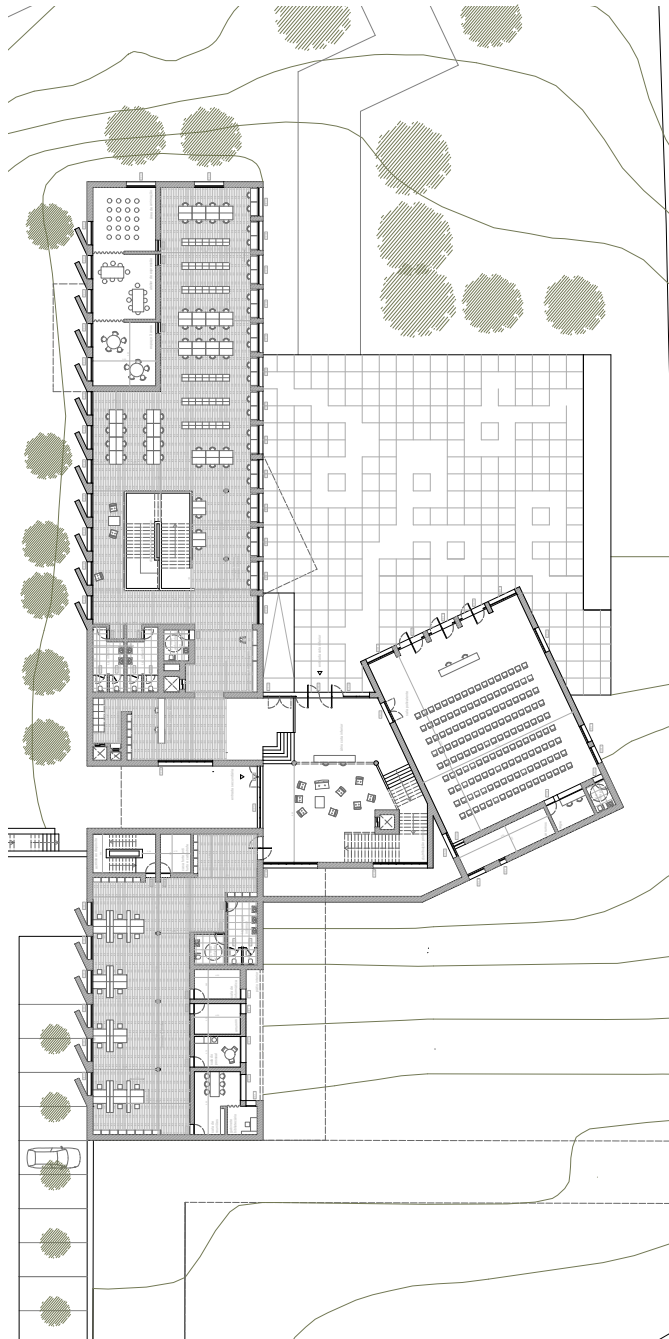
Planta cotas 83 e 84. Desenho da autora
